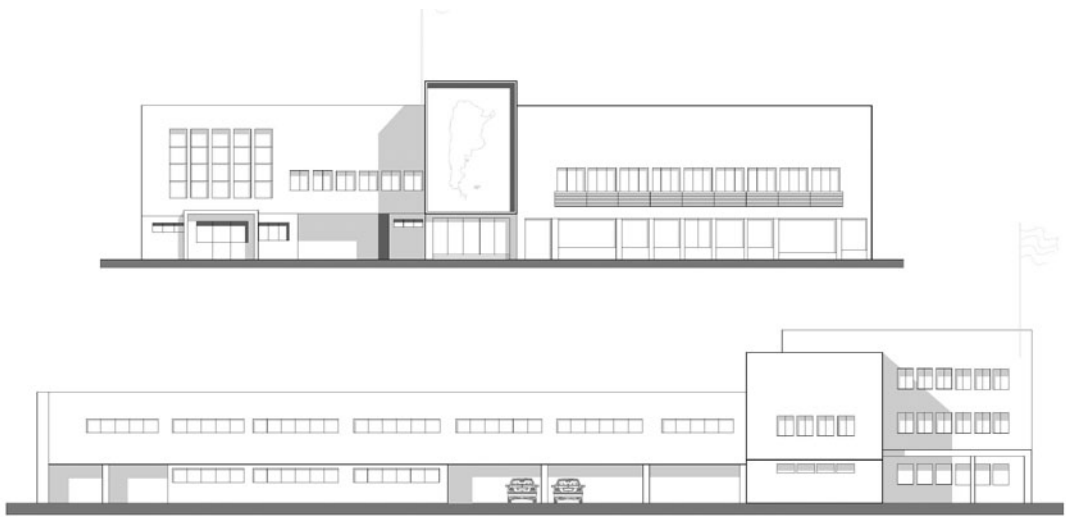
Fachadas del conjunto Aca en Mendoza. Proyecto original. Fuente: Alejandro Geuna (redibujado del original) 2013
